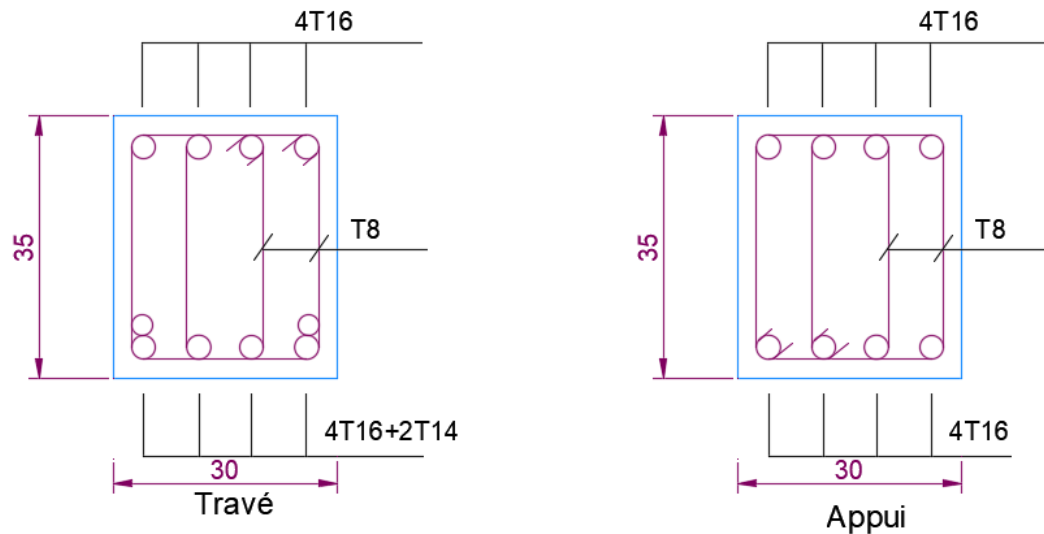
Schéma de ferrailage des poutres non porteuses
